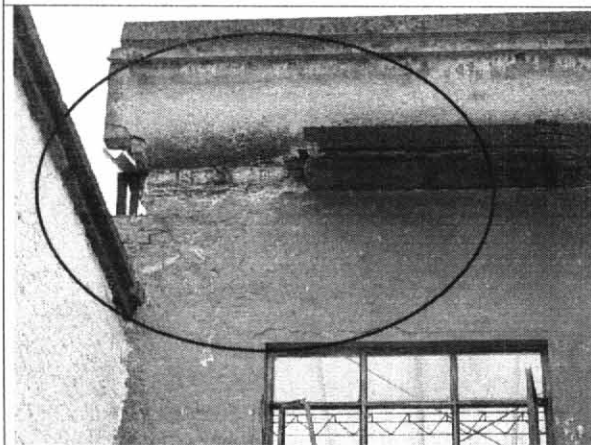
Fragmentos de muro sueltos y desprendimiento de piezas de mampostería en fachada.
